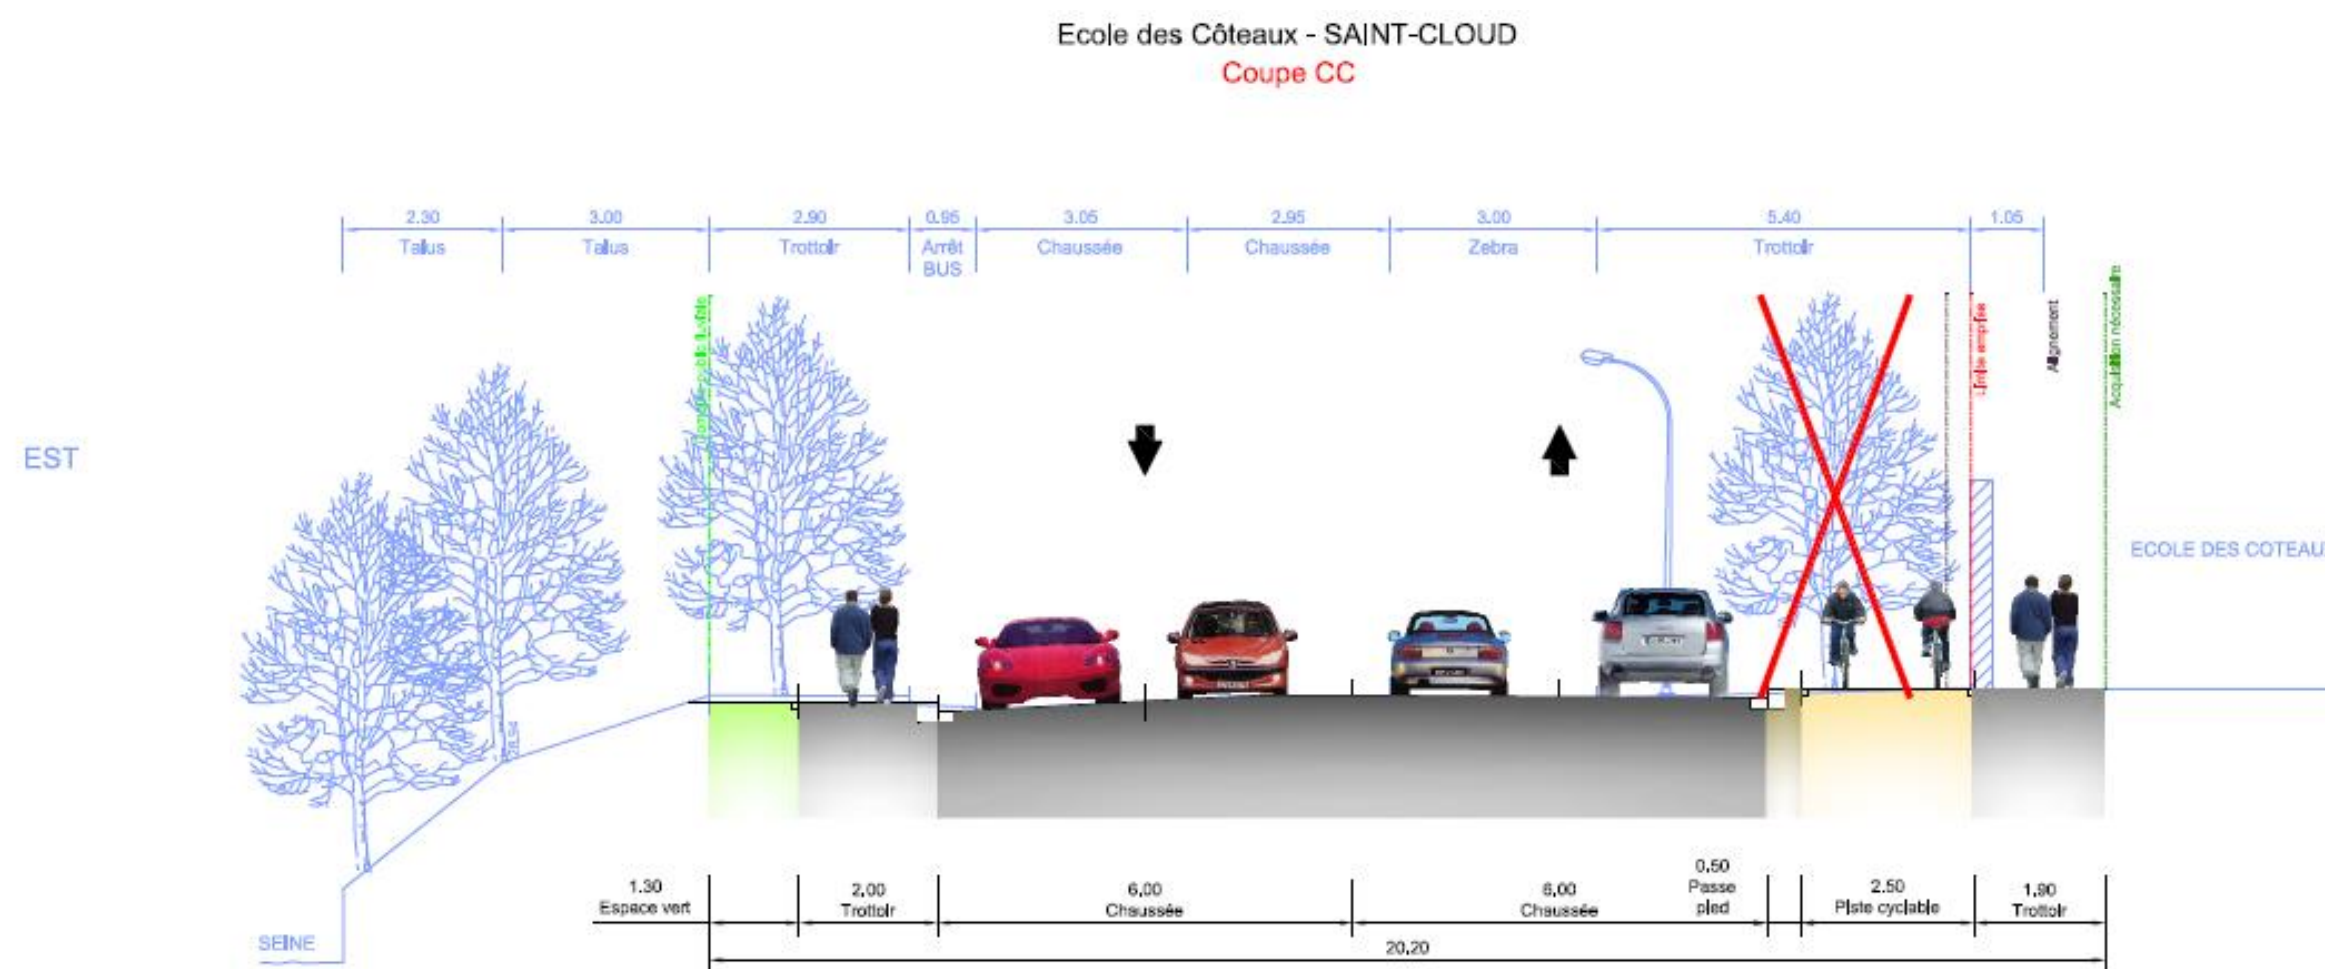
profil en travers du projet sans promenade paysagère (2014) au droit de l'école des Coteaux
